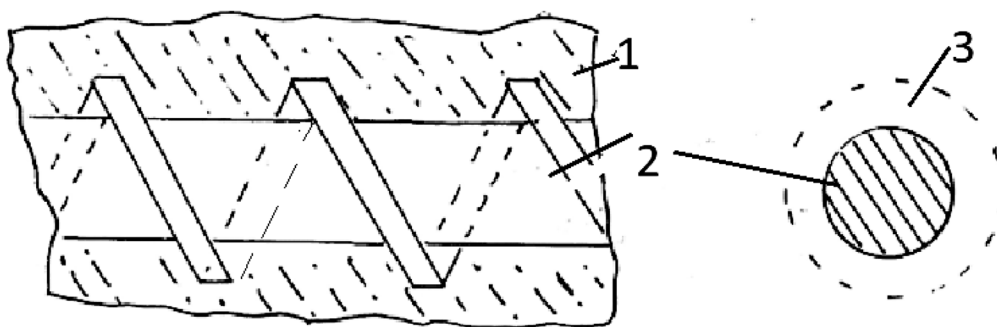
1 – Бетон; 2 – стержень с резьбой (3)
